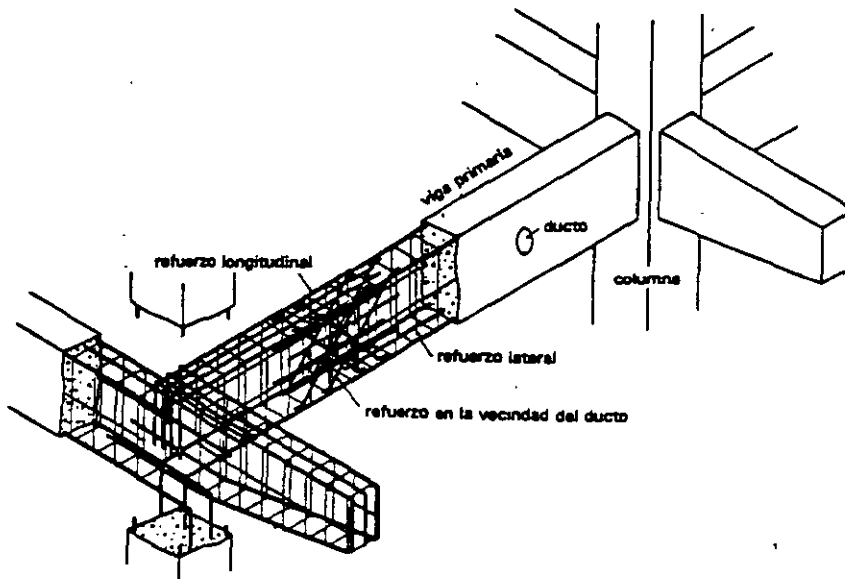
Detalle de refuerzo para ductos en el alma de viga
